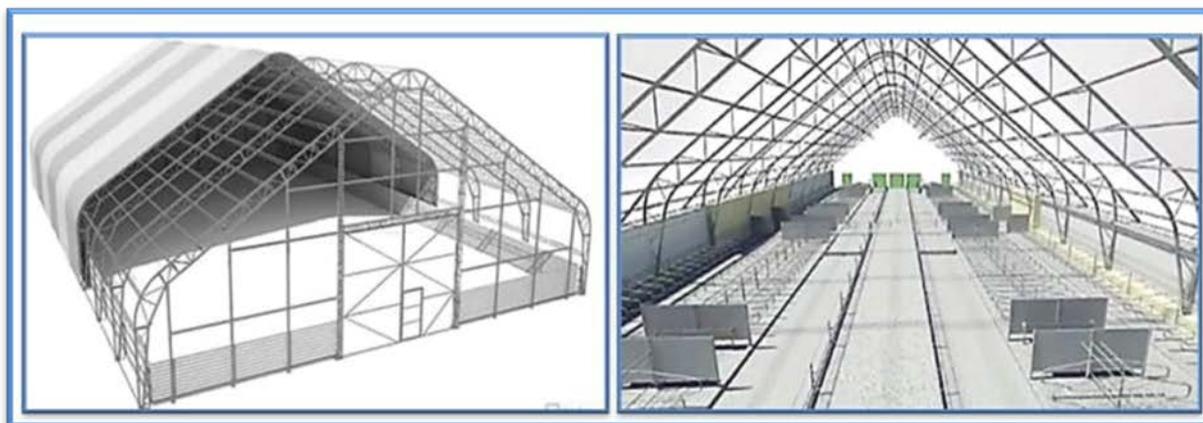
Широкогабаритный каркасно-тентовый коровник из металлических конструкций
